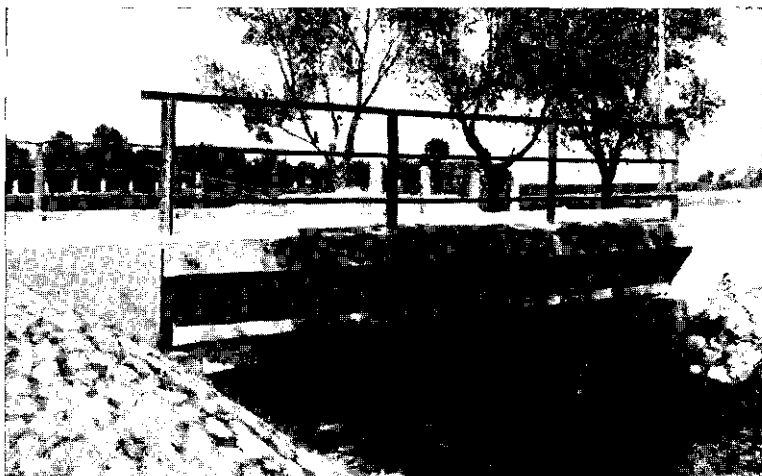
Przepust betonowy płytowy 1,8 metra światła obok Stryja na drodze Lwów-Klimiec. Widok wkładek żelaznych.
